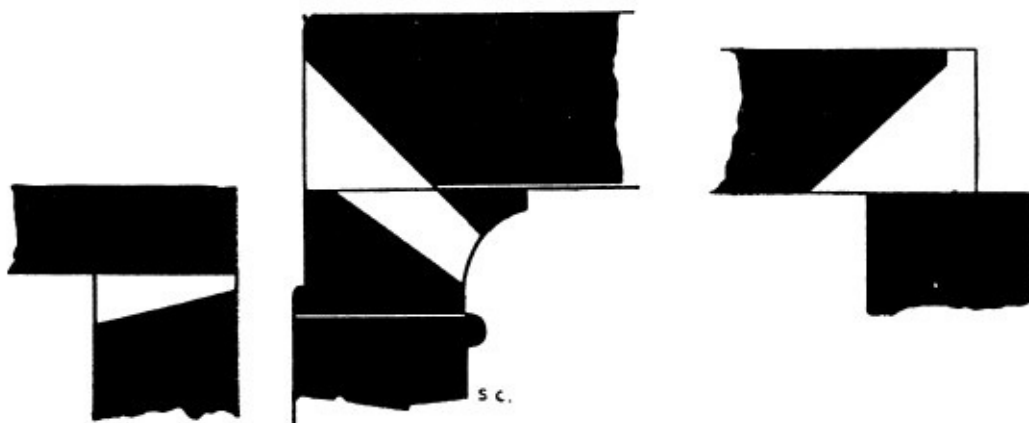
Сечения световых отверстий между стенами и плитами крыши в храме Тутмеса III в Мединет-Абу
